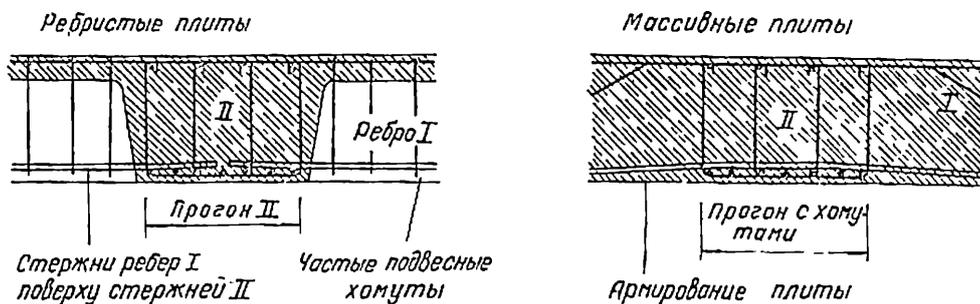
5. В ребристых перекрытиях нижние стержни поперечных ребер должны быть уложены над основной арматурой прогона; должно быть поставлено достаточное количество хомутов для подвески нагрузок, передающихся от ребер
